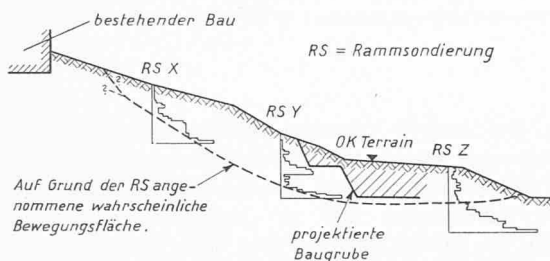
Rammsondierungen zur Beurteilung, ob das bestehende Gebäude durch die geplante Baugrube gefährdet ist
